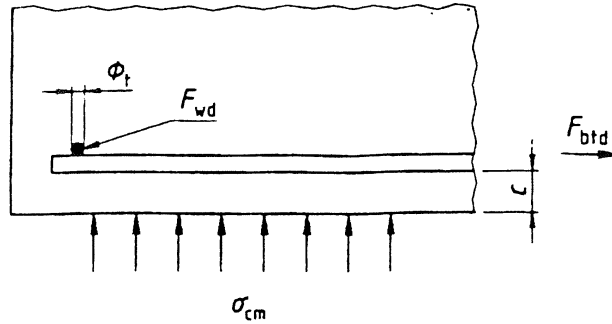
Barre transversale soudée servant de dispositif d'ancrage
